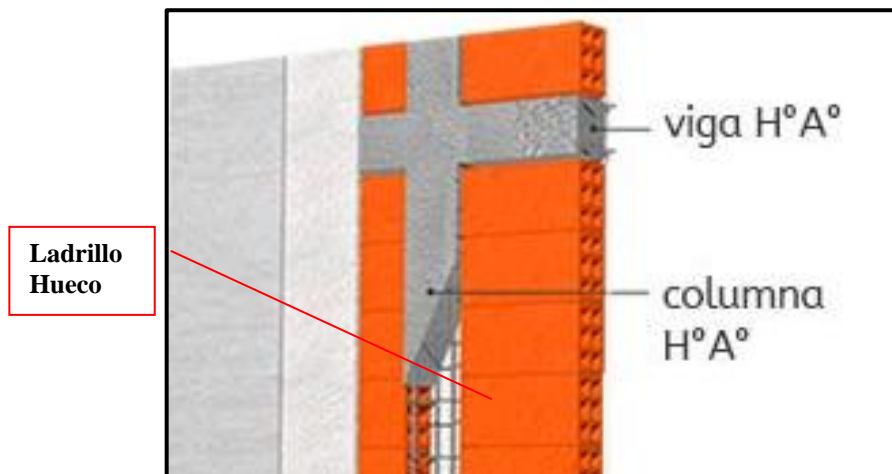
Vista de Muro de ladrillos hueco y estructura de H° A°
